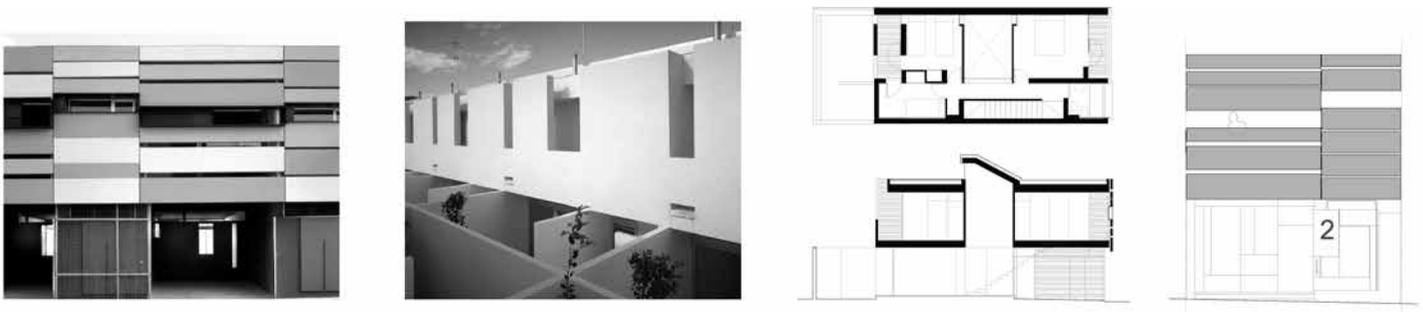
LORQUÍ, alzado exterior, vista espacio intermedio, planta y sección
